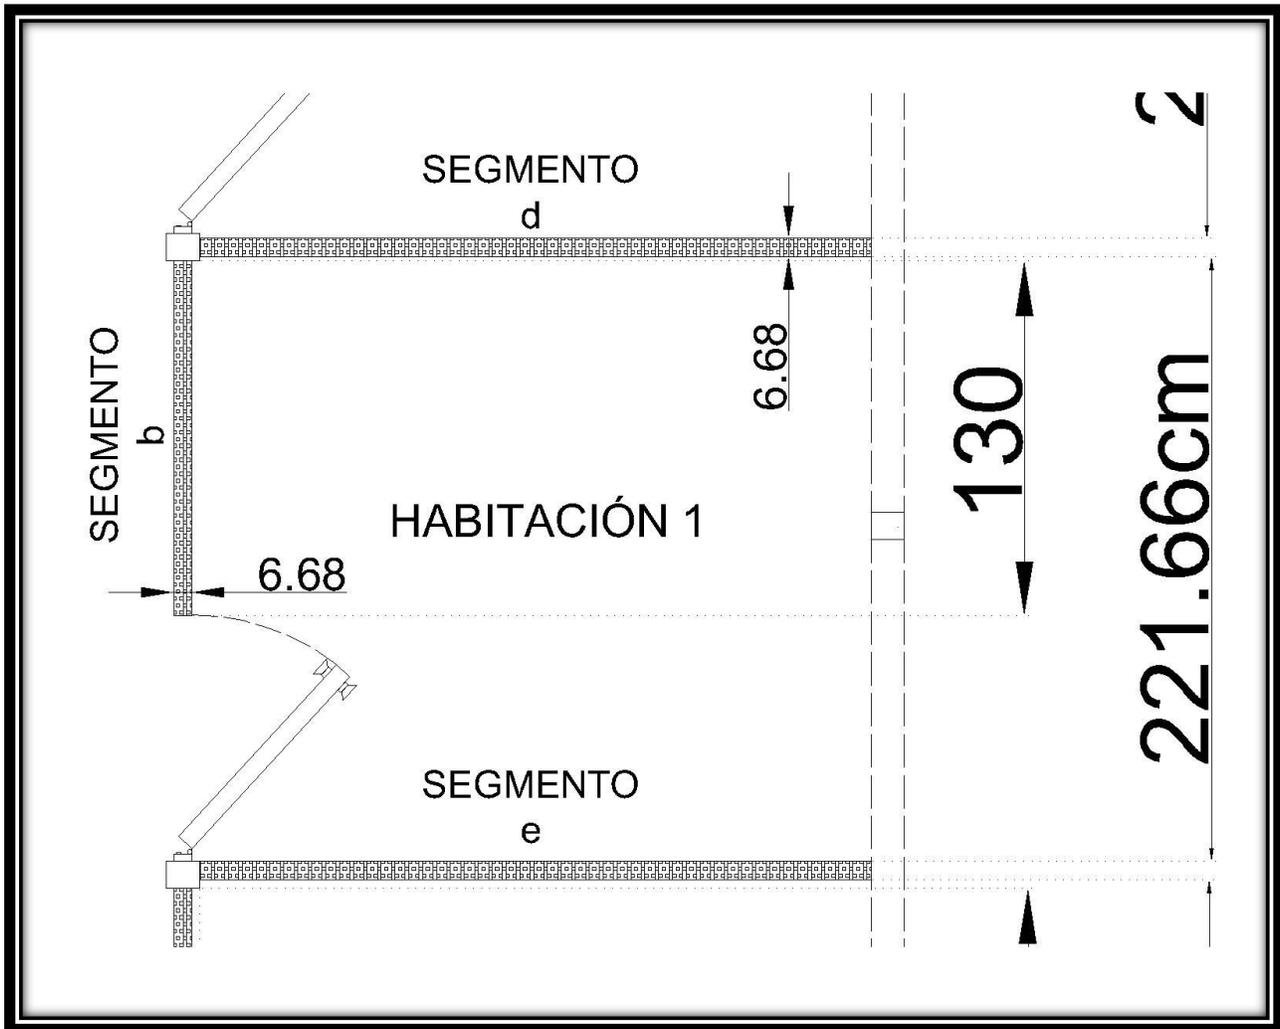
Muros con Paneles de Yeso. Detalle Habitación 1.
